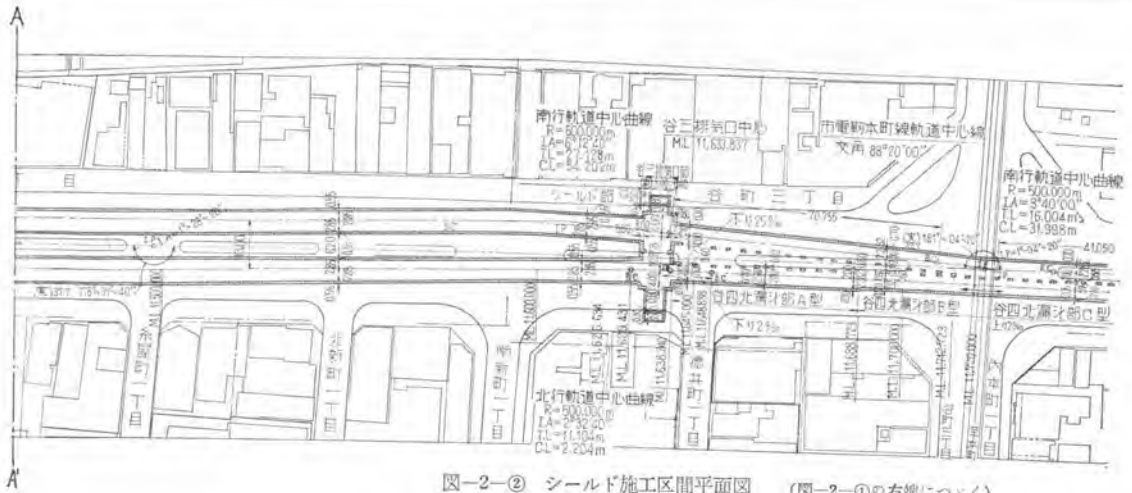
② シールド施工区間平面図 (図-2-①の右端につづく)
